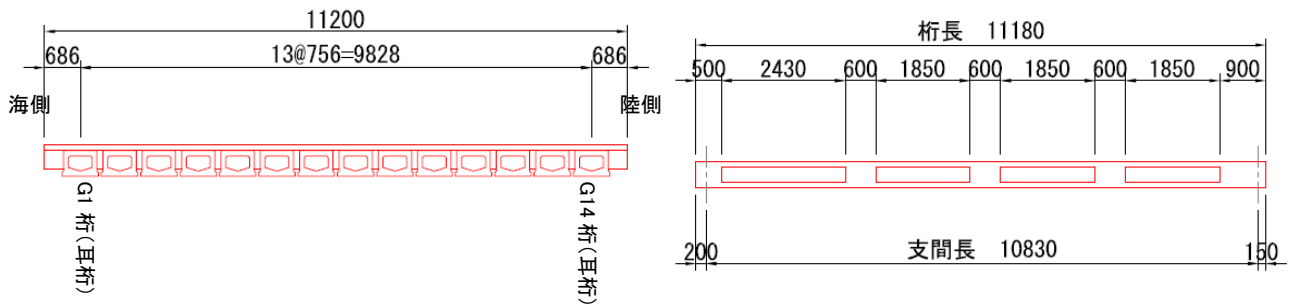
PC 桁部断面図（左：断面図，右：正面図）
